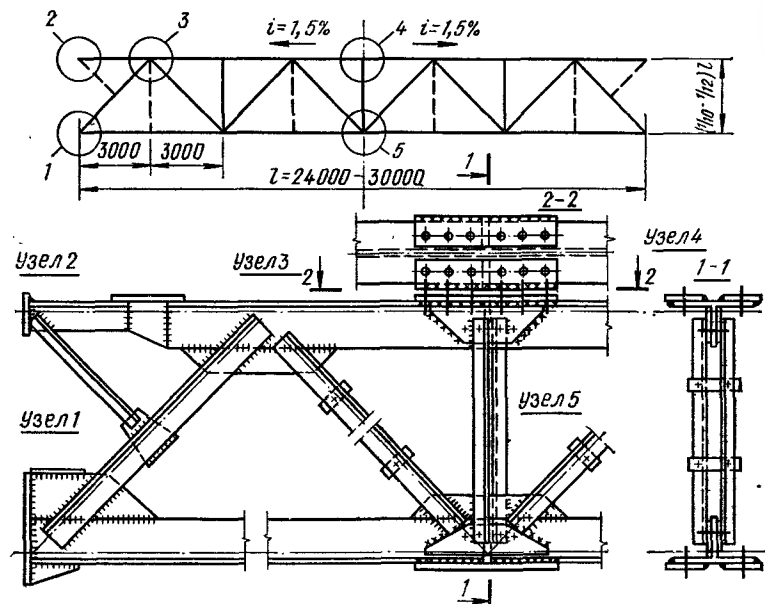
Узлы типовых стропильных ферм с поясами из широкополочных тавров
